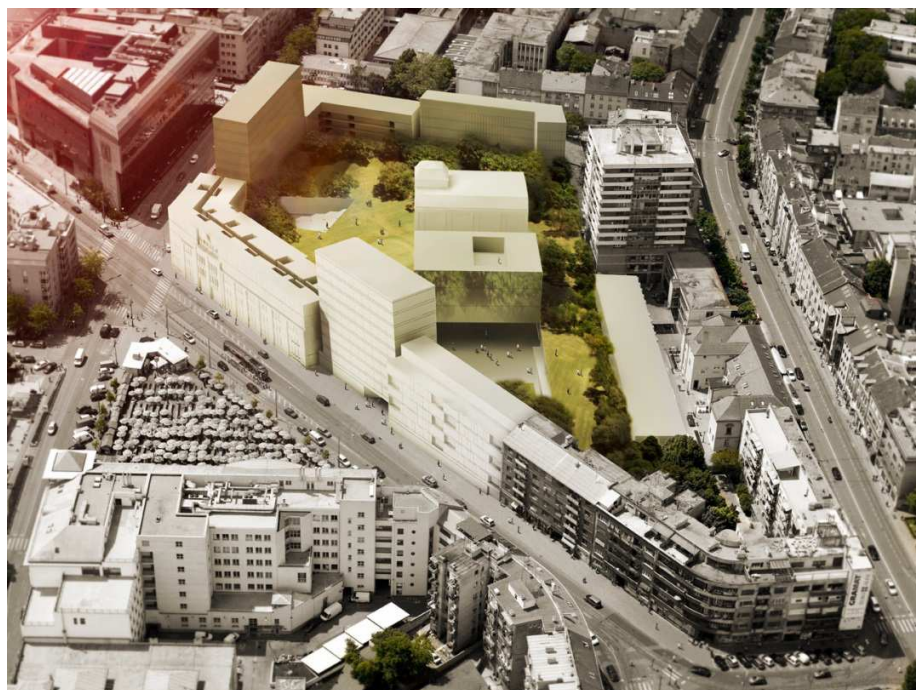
Pablo Pita Architects, Blok Badel – 1. nagrada, situacija
